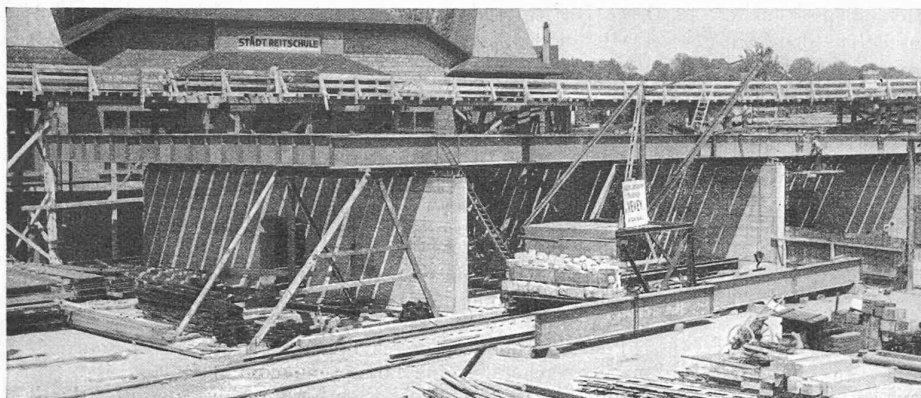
Dalles du lot 5 a portées par des parois articulées en béton armé. Poutrelles continues Die 100, renforcées par des semelles soudées en acier 44
